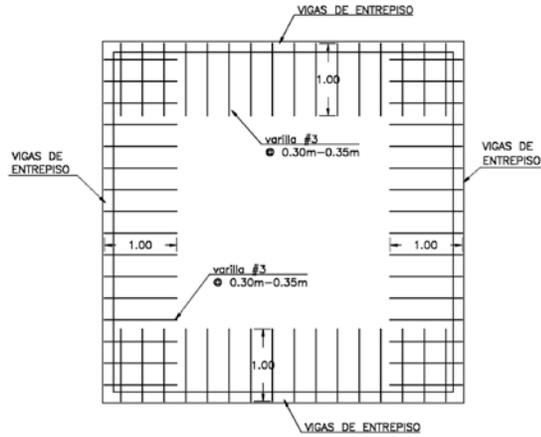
Vista en planta de refuerzo sísmico de entepiso
